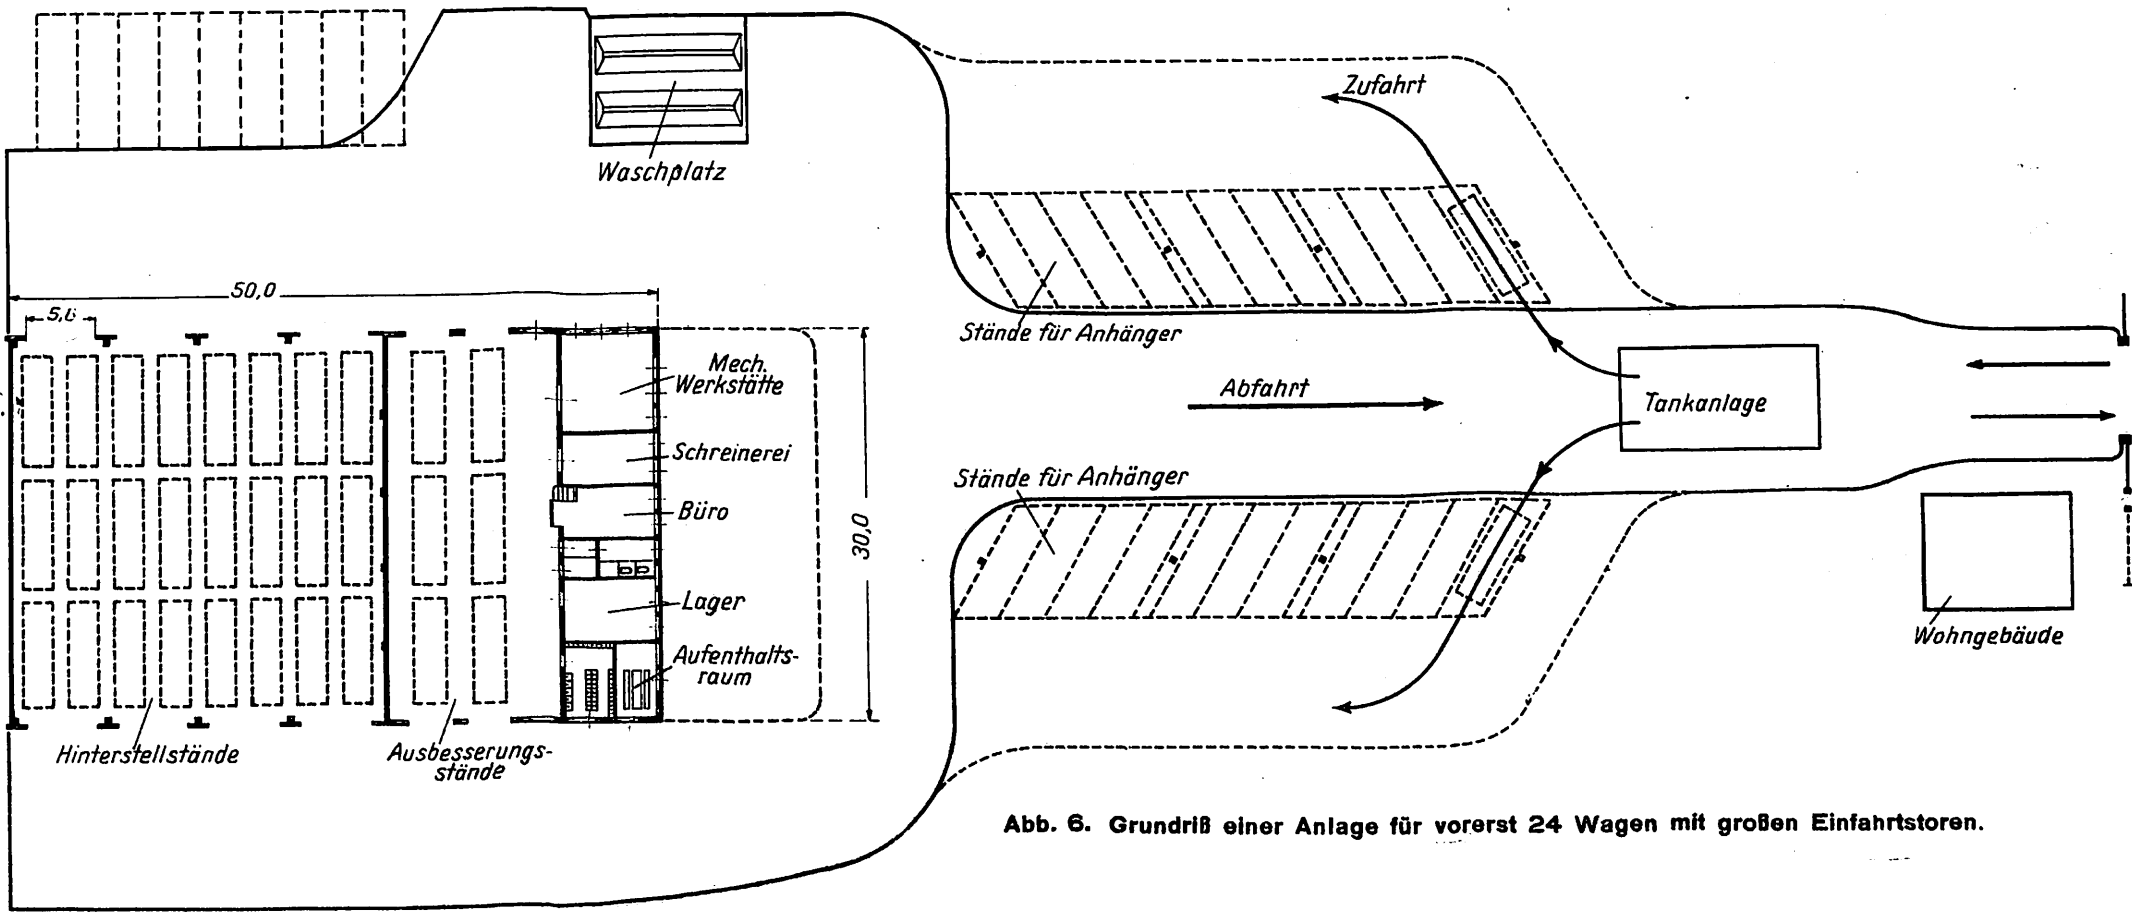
Grundriß einer Anlage für vorerst 24 Wagen mit großen Einfahrtstoren.
